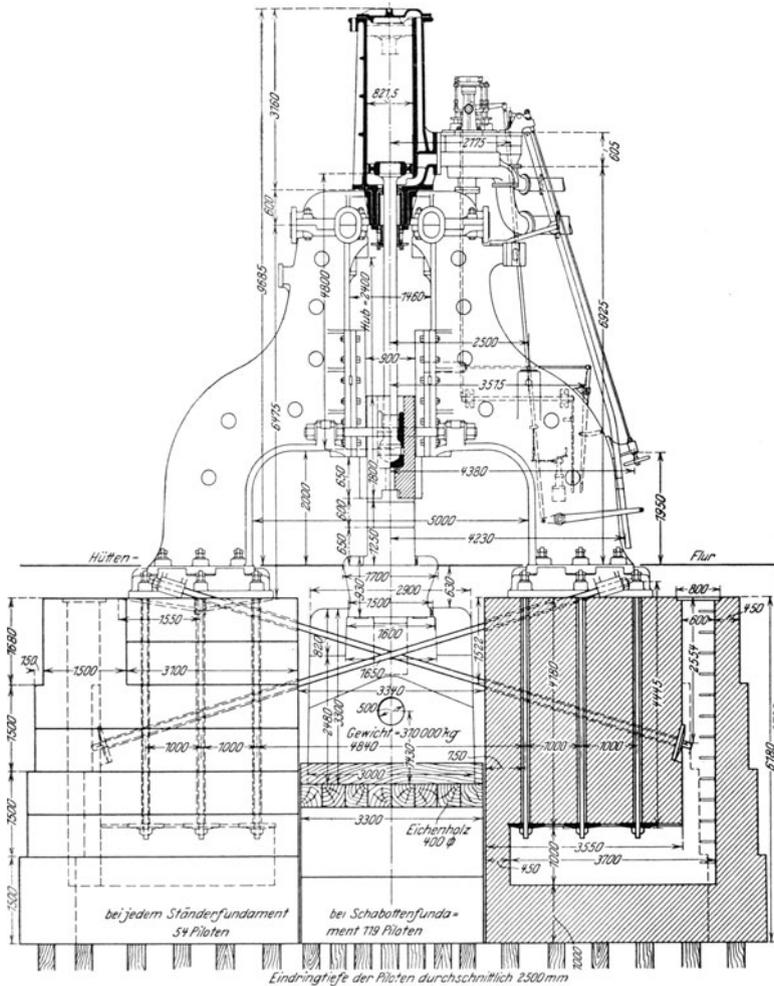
Gründung eines Dampfhammers von 15 t Fallgewicht.
